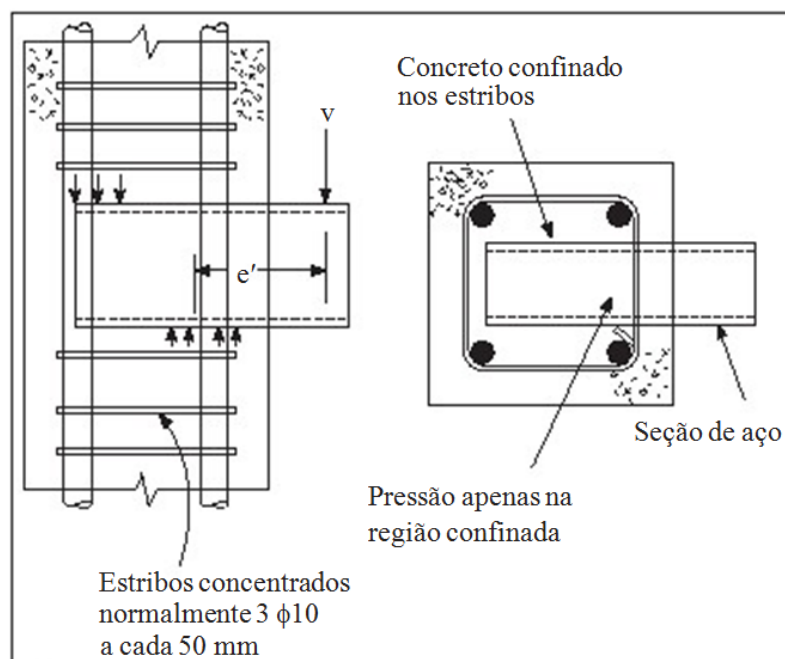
Caixa de cisalhamento – *shear box* – pré-fabricada (perfil metálico de Seção Retangular Oca – SRO).
